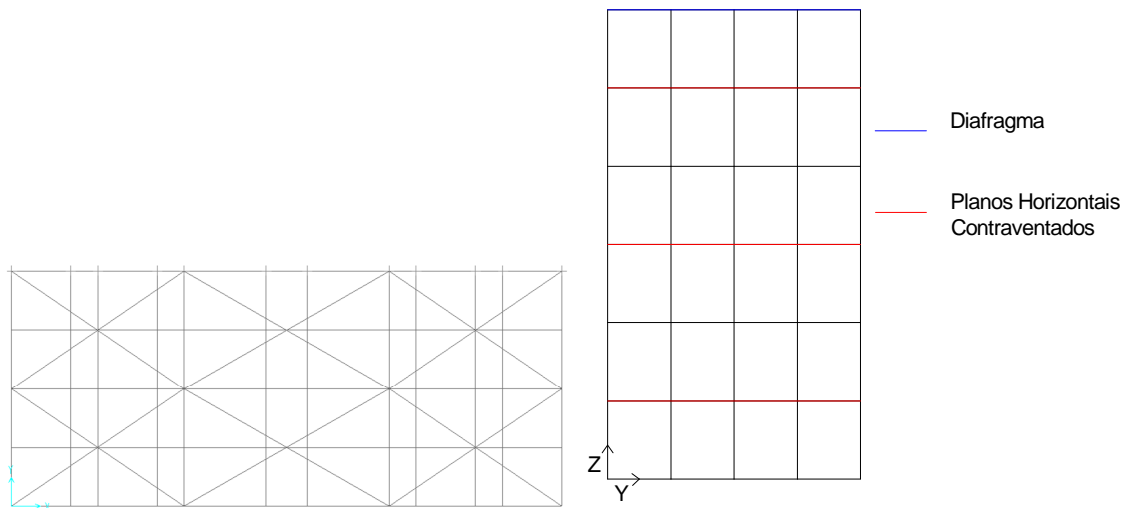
Configuração dos Planos de Contraventamento Horizontal Com Elementos de Contraventamento Grandes
